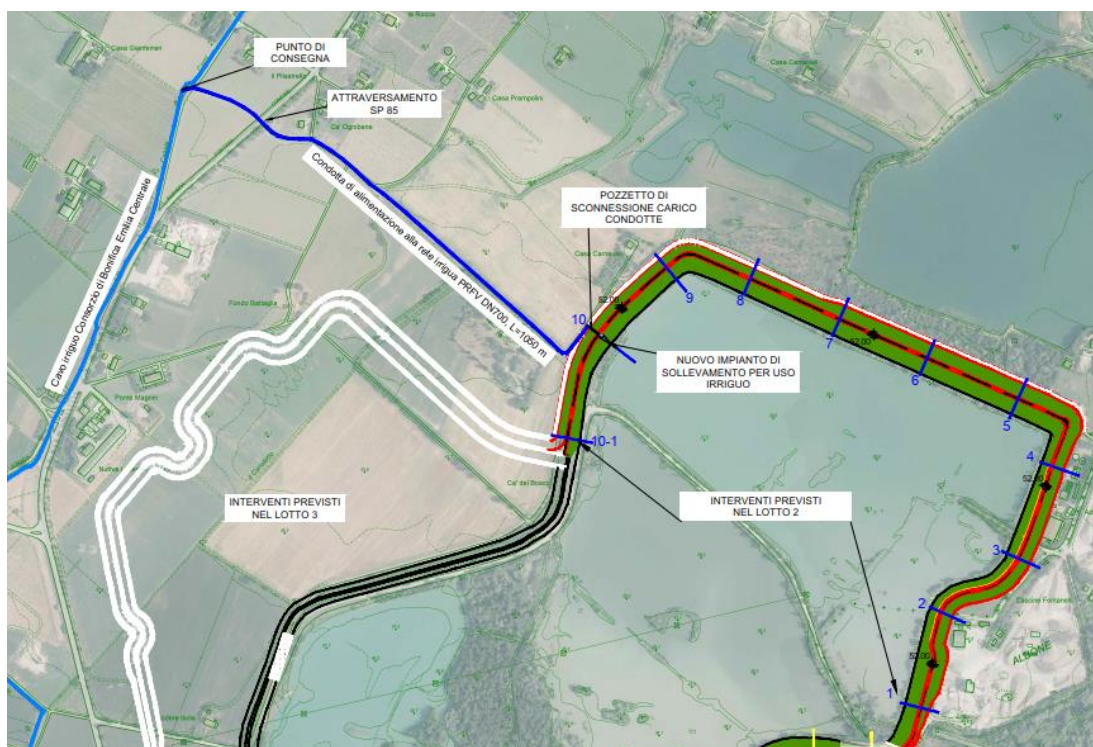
Stralcio della planimetria di progetto con indicati gli interventi previsti nel IV lotto
